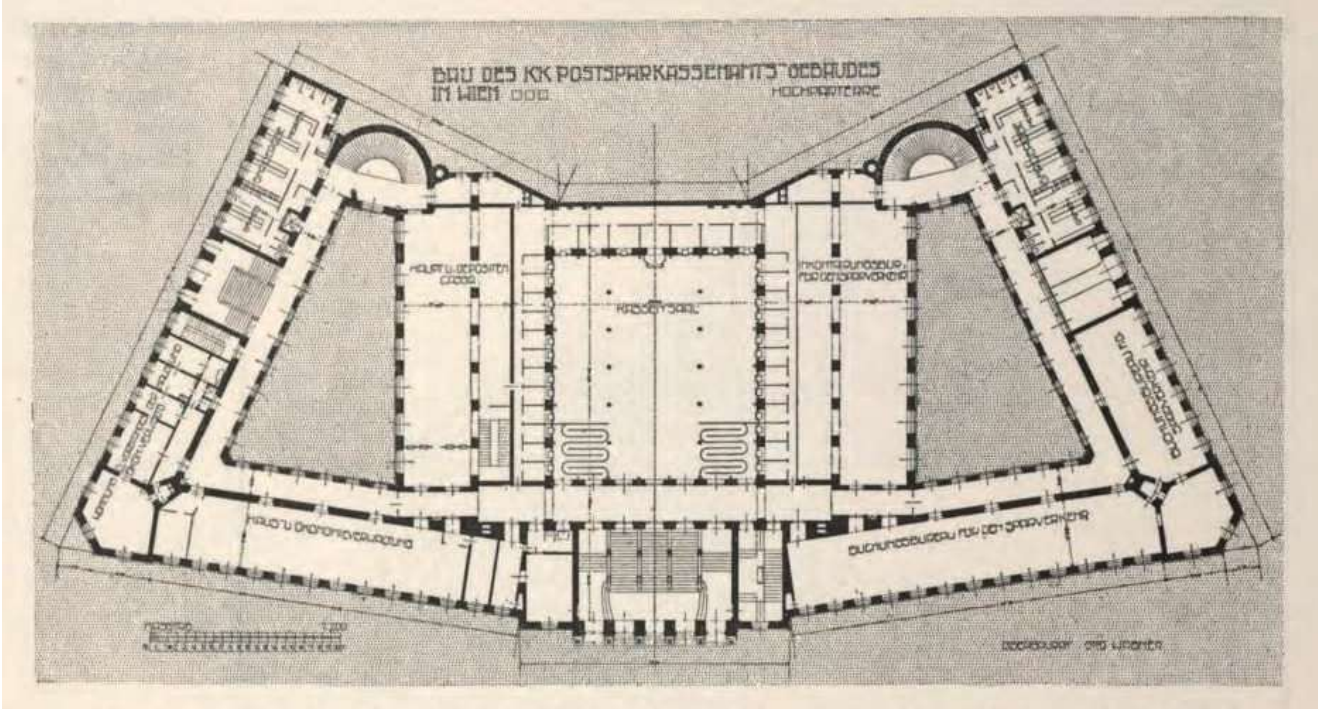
Grundriss 1. Obergeschoß des Postsparkassenamtes von Otto Wagner (1903)
